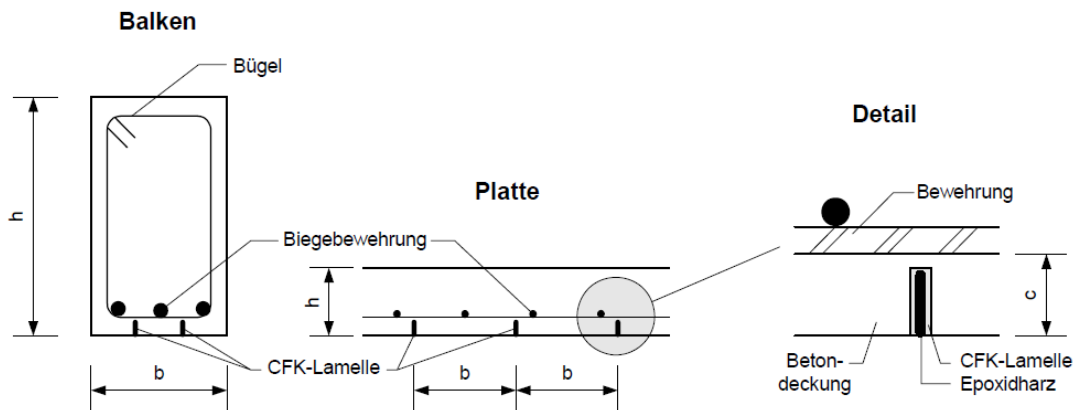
Bauteilverstärkung mit einer eingeschlitzten Kohlenstofflamelle<sup>16</sup>
